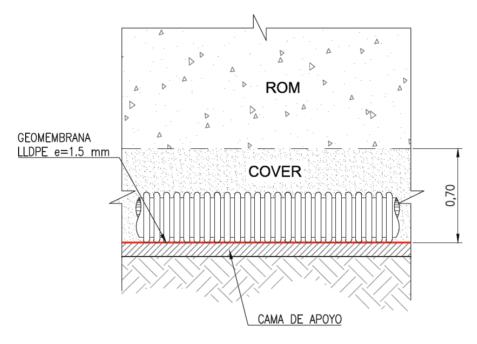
Control de infiltraciones pila ROM Esperanza Sur
